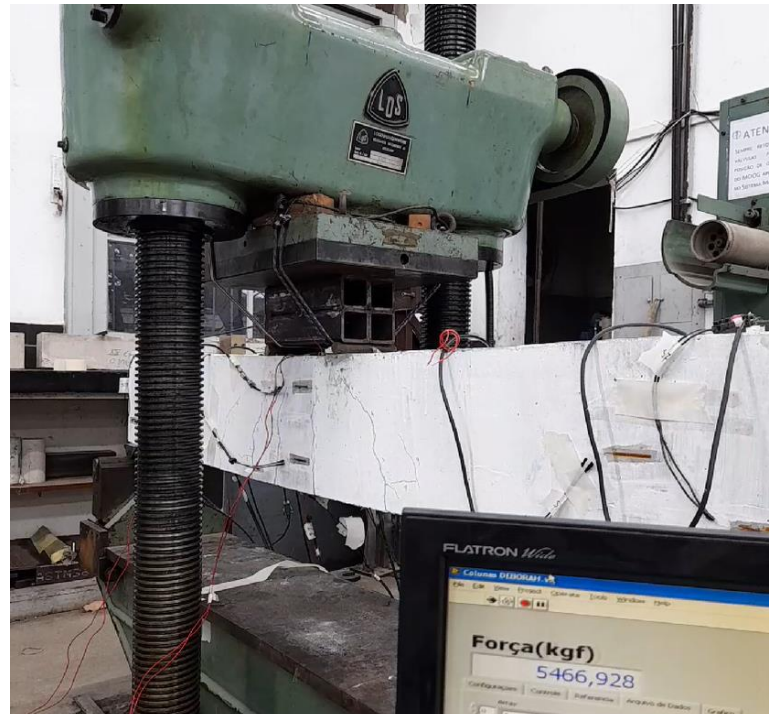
Viga 1 (viga convencional) momento em que a viga chega a ruptura
